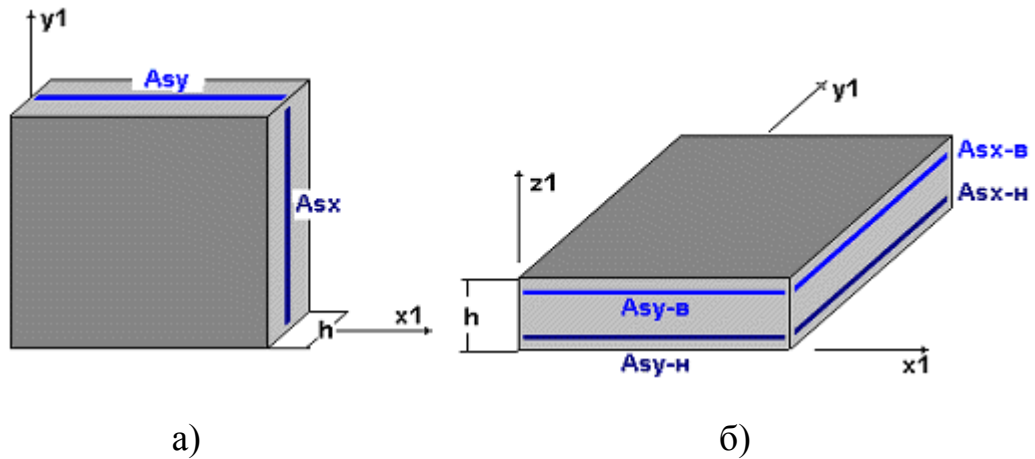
Схеми розташування поздовжньої арматури:
